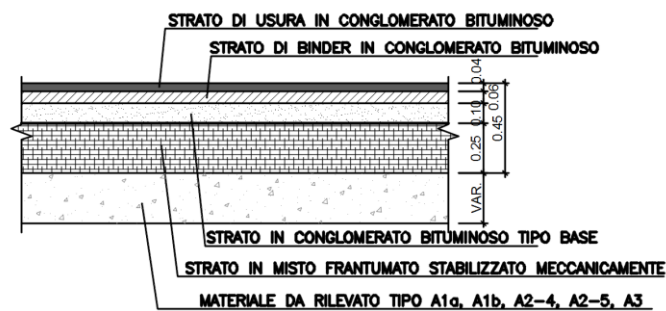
Pacchetto pavimentazione nell'opera di progetto
